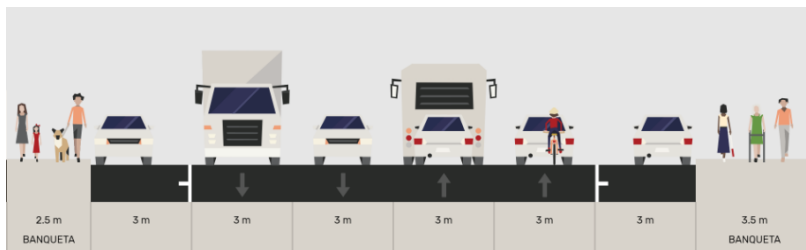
Vialidad Av. Vallarta y su sección vial actual. Fuente PDU 2040 vigente.
